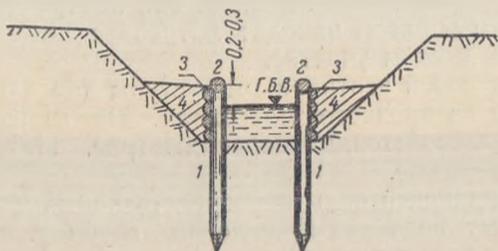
Крепление откосов вертикальной стенкой из пластин:
